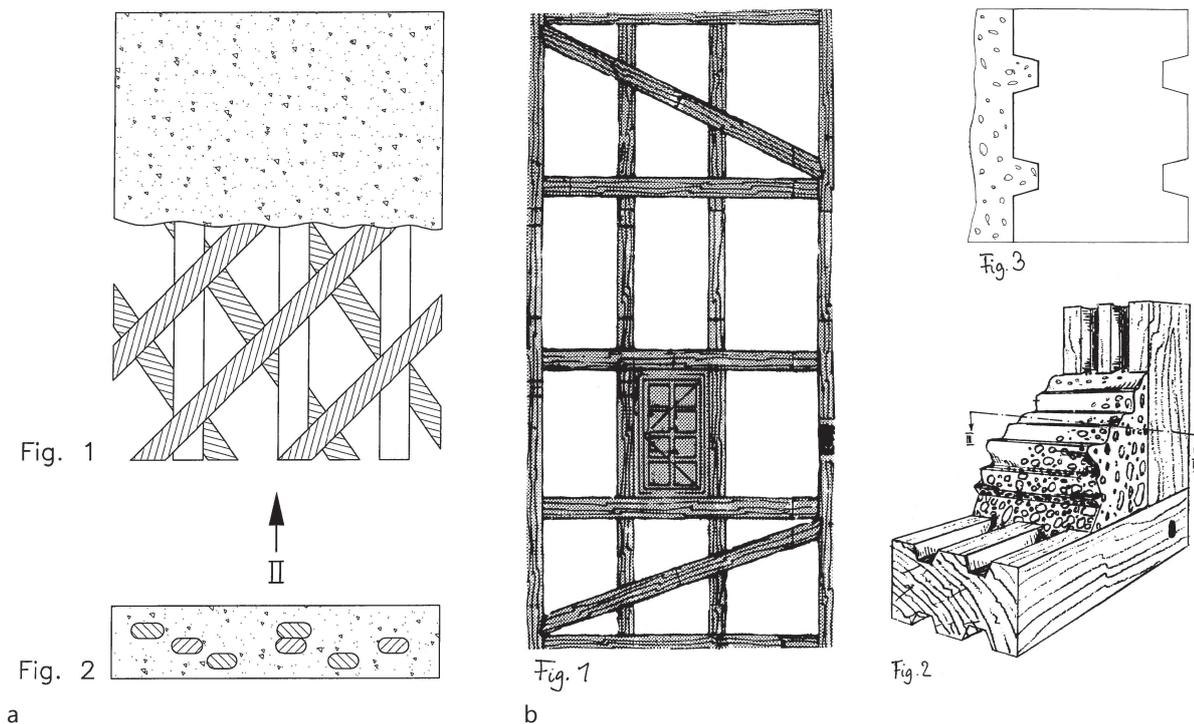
Varianten von Holzverstärkten Holzleichtbetonwänden; a Holzständer mit Diagonalverstrebung in HLB-Verguss; b Holzfachwerk mit HLB-Füllung in vorgefertigten Nuten
